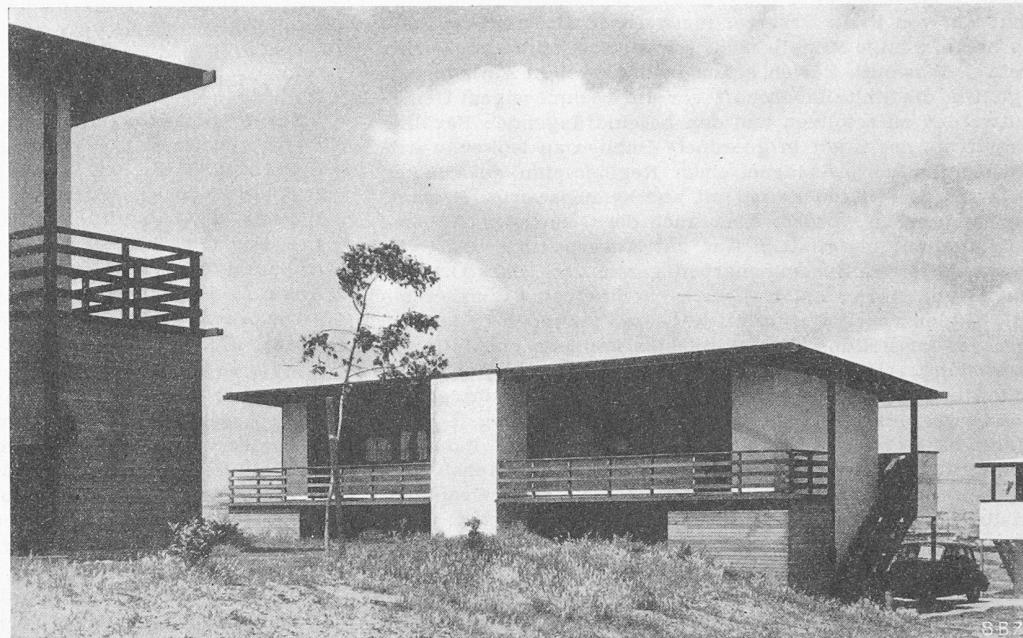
Zweistöckiges Doppelhaus mit vier Zweizimmerwohnungen (Bild 8)
